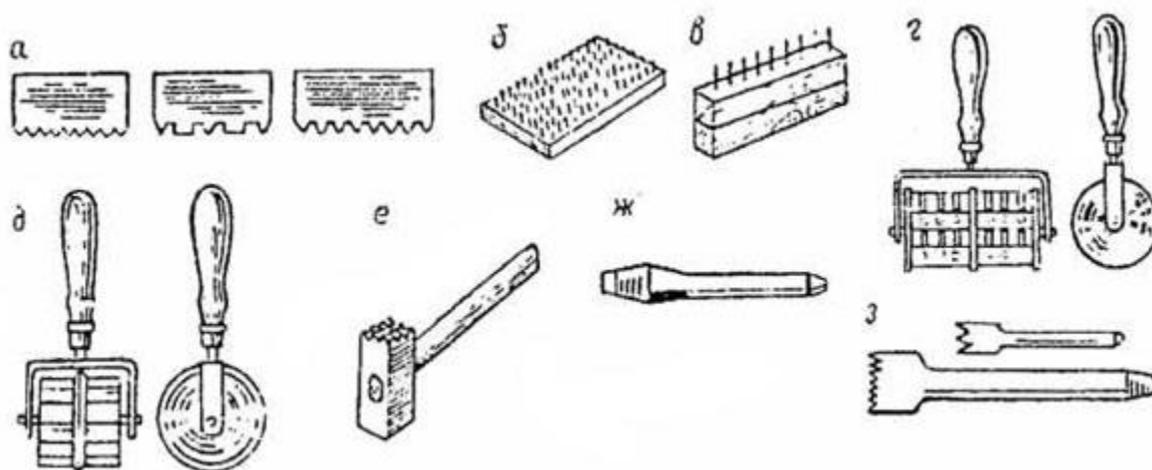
Инструменты для обработки декоративной штукатурки: а - цикли; б - гвоздевая щетка; в - гребенка; г - валик; д - валик-шовник; е - бучарда; ж - зубило, з - троянка и зубчатка
